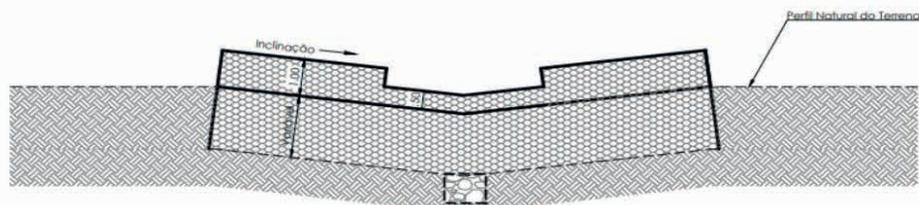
Proposta de drenagem de fundo da voçoroca com utilização de rachão e manta geotêxtil (PRISMA CONSULTORIA, 2021)
